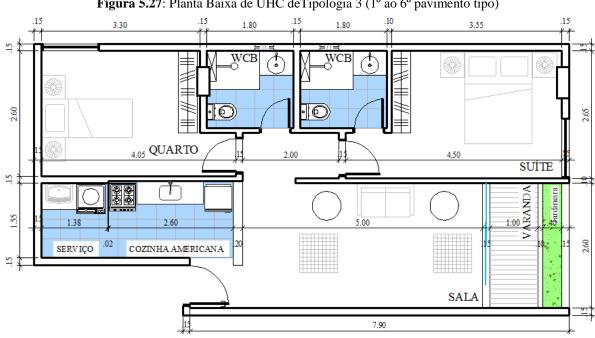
Planta Baixa de UHC de Tipologia 3 (1º ao 6º pavimento tipo)
